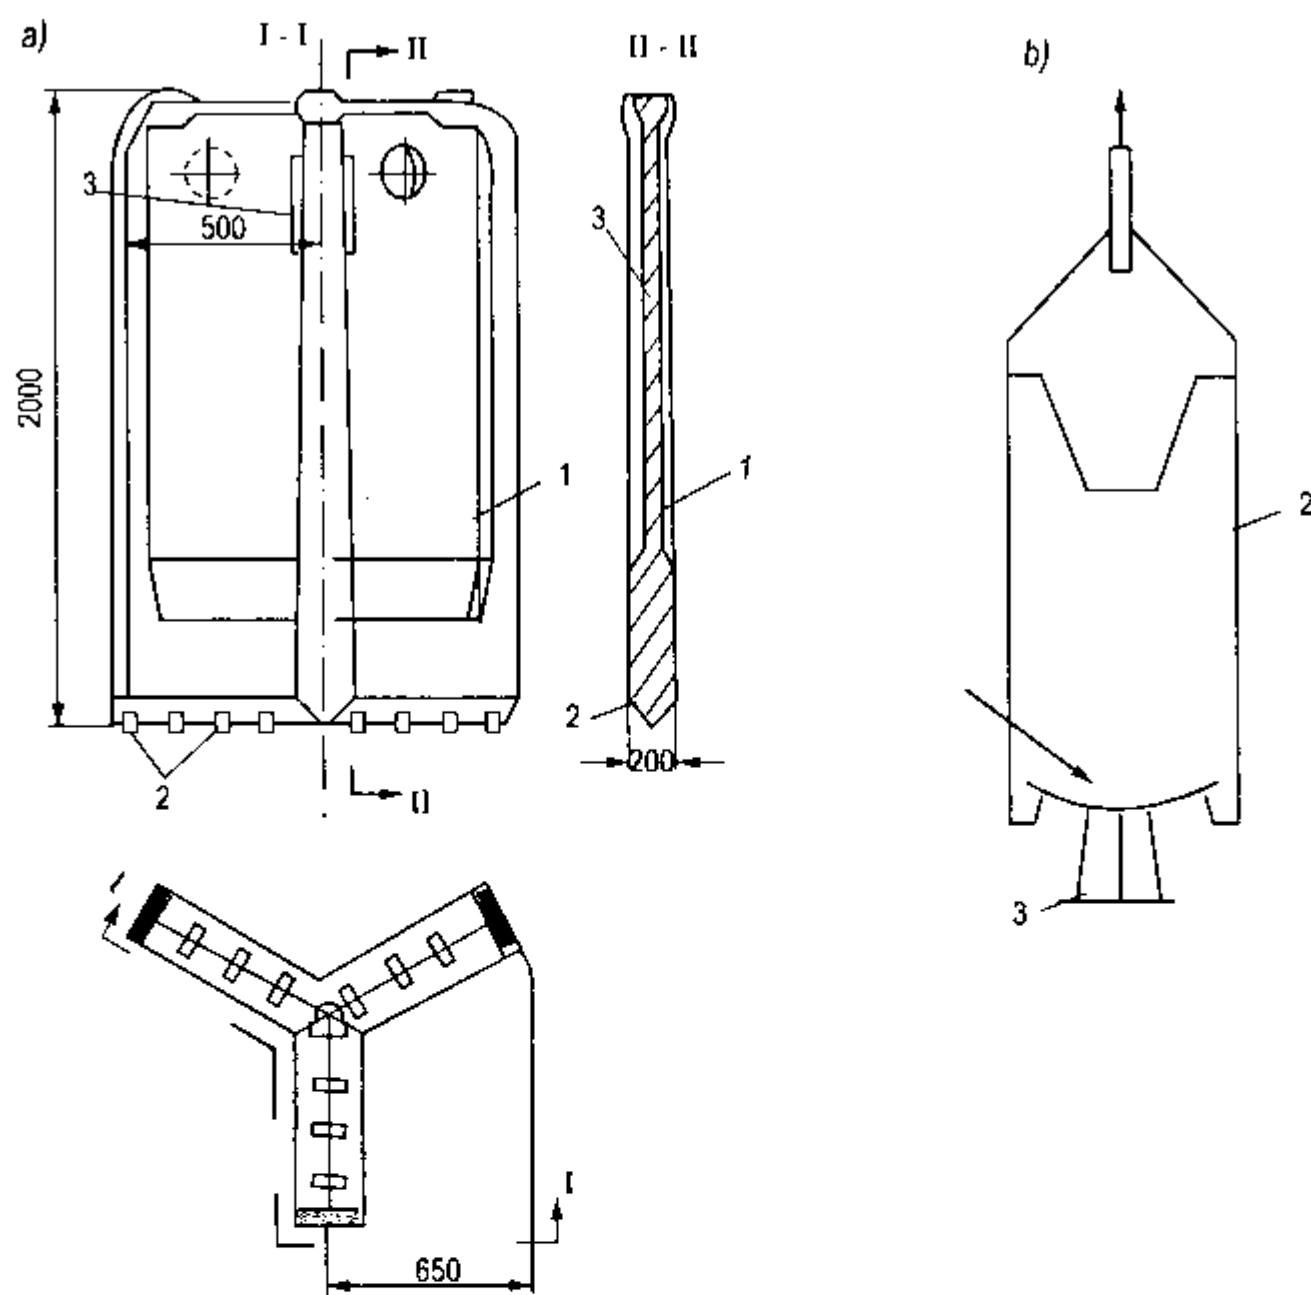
Cấu tạo búa khoan xung kích YKC - 30 (Liên Xô cũ)
